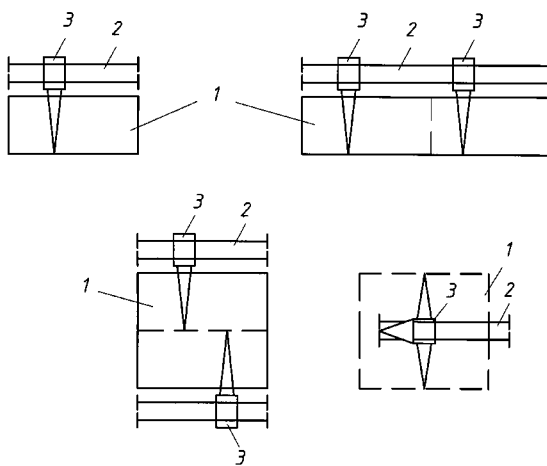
Варианты расположения башенных кранов при монтаже многоэтажных зданий: 1 – монтируемое здание; 2 – подкрановый путь; 3 – башенный кран
